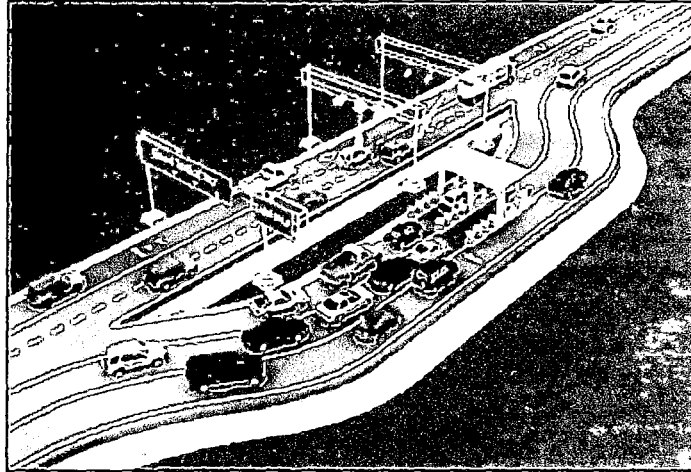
Primer Open Road Tolling en el Parque Irving Rd. Plaza de peaje.
